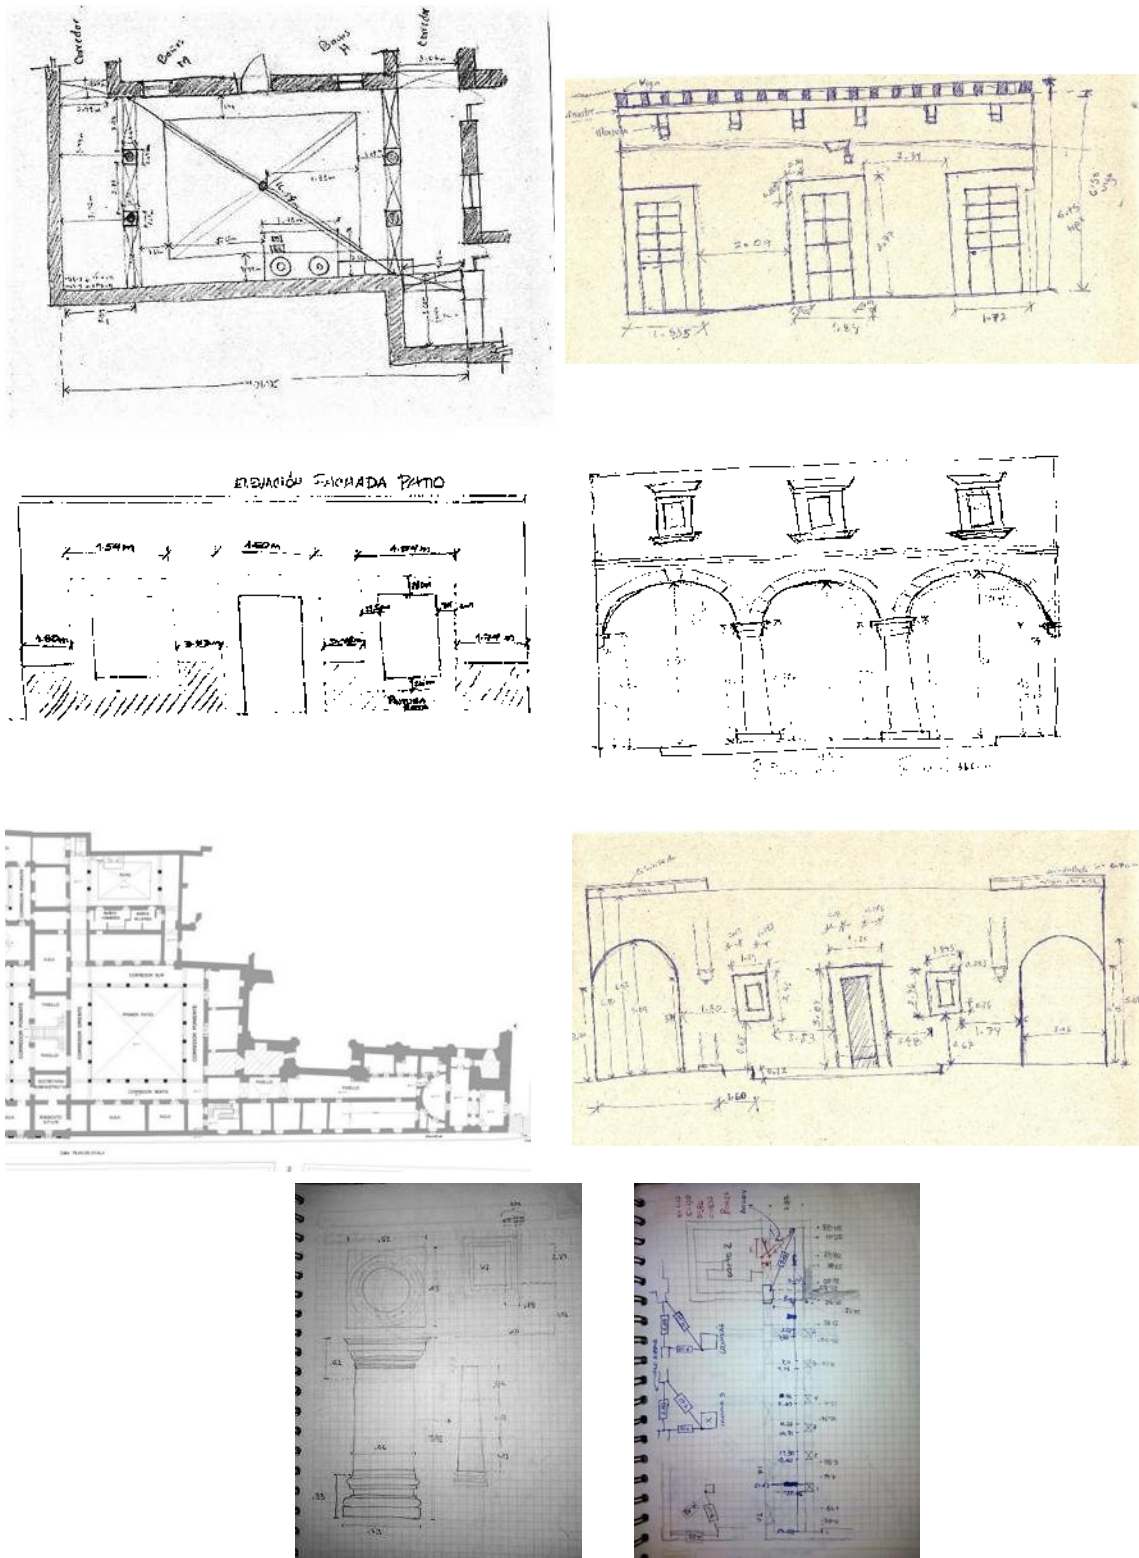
Croquis de Levantamiento arquitectónico. Elaborados por estudiantes de la ERSM.
